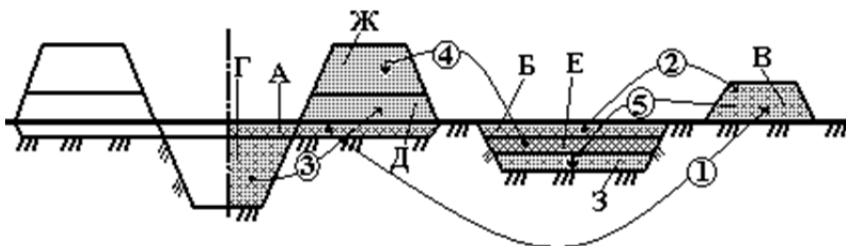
Схема переміщення ґрунтових мас при будівництві зрошувального каналу у напівнаси́пу з роздільним влаштуванням дамб: А – рослинний шар ґрунту на поверхні виїмки каналу і в основі
